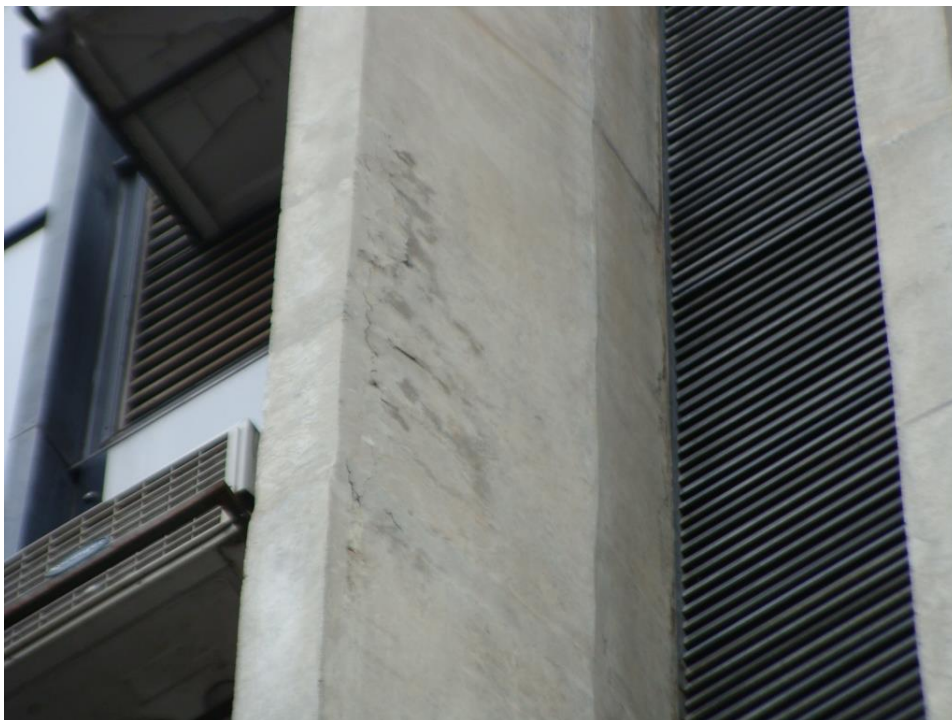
Armadura exposta pilar P12 (3º pavimento) (02/03/2021)
